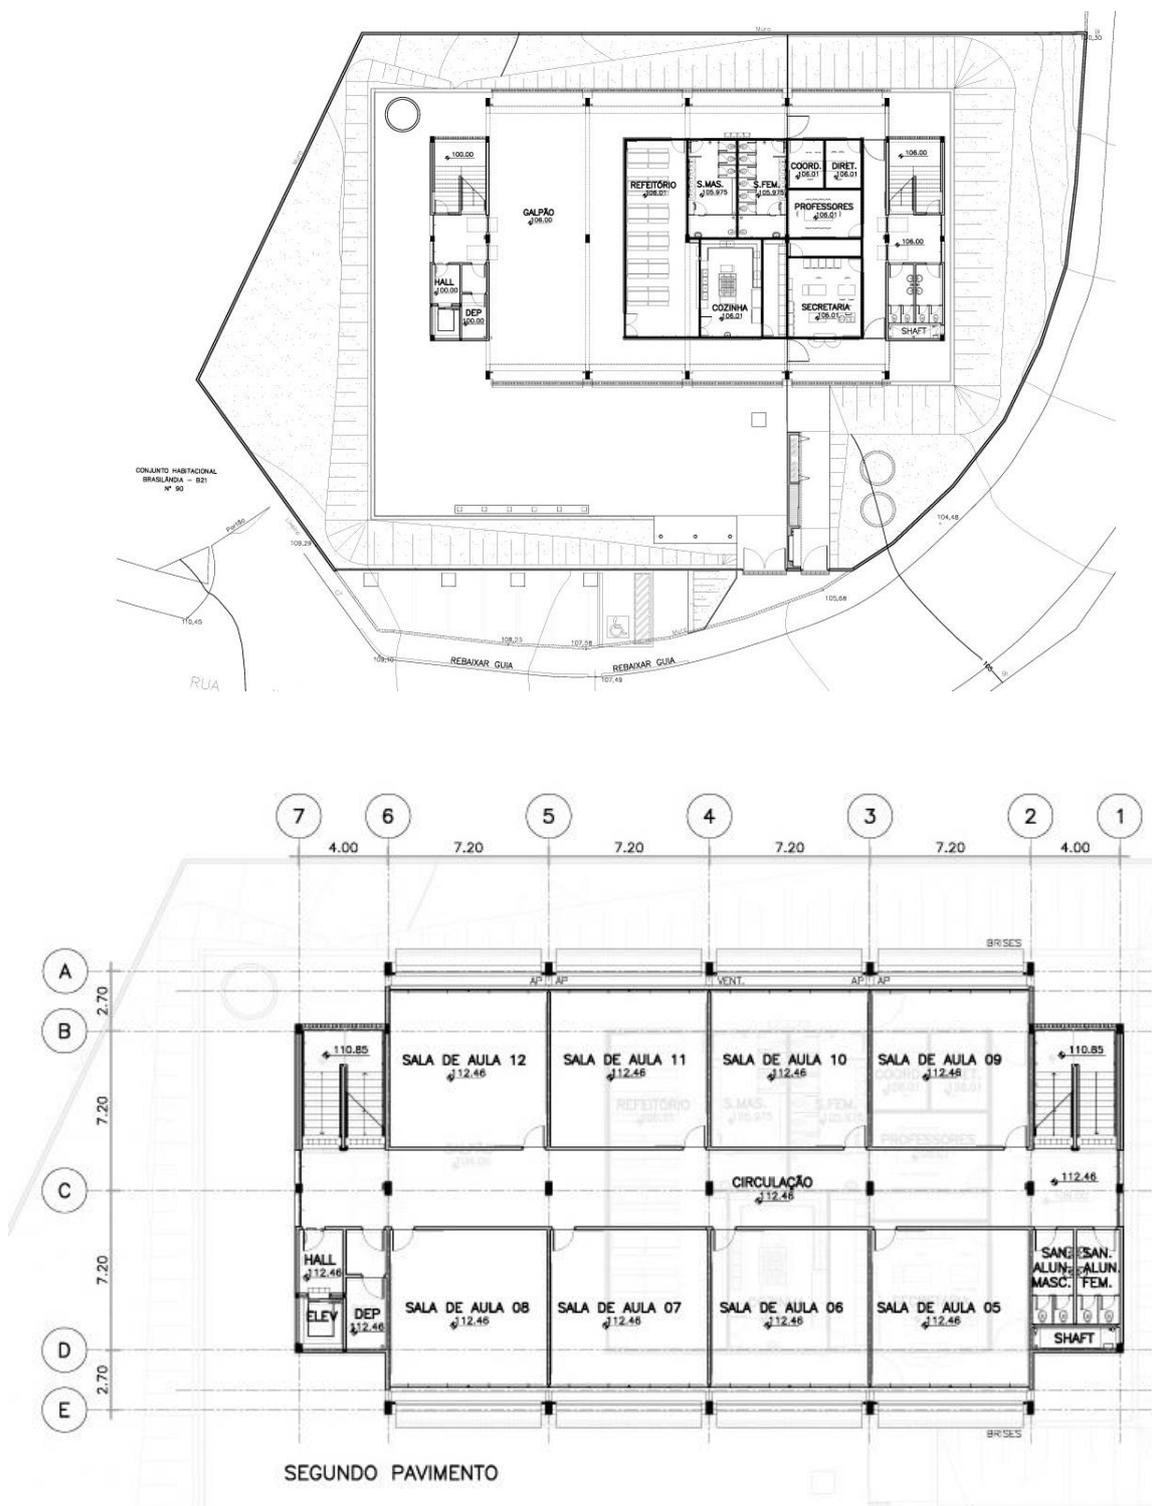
B- Plantas do Térreo e do Segundo Pavimento do C.E. Ilha da Juventude (sem escala). Fonte: www.metropole.arq.br/institucional/EE-Ilha-da-Juventude (2017)²⁷
